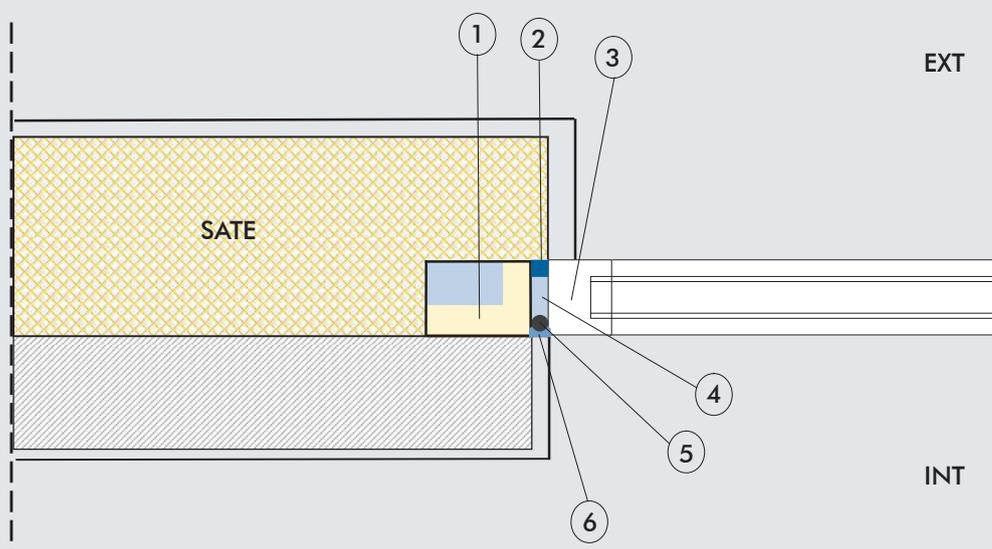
Cinta expansiva, espuma y sellador interior con fondo de junta SATE (solapada) + Premarco aislante
